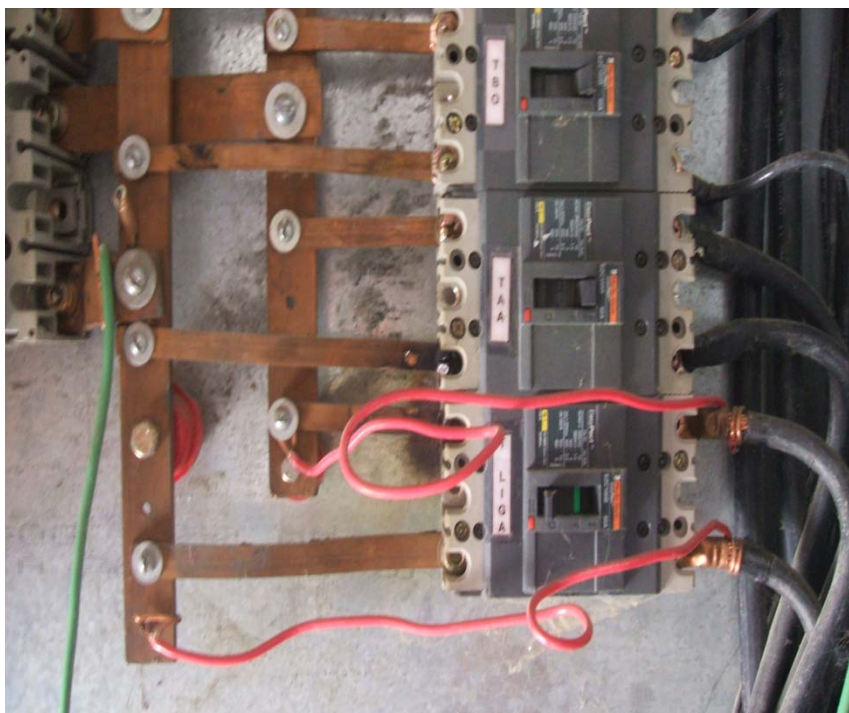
Conexión eléctrica entre barraje de Tablero General TGB y acometida de alimentación de Tablero de Liga de Boxeo.
